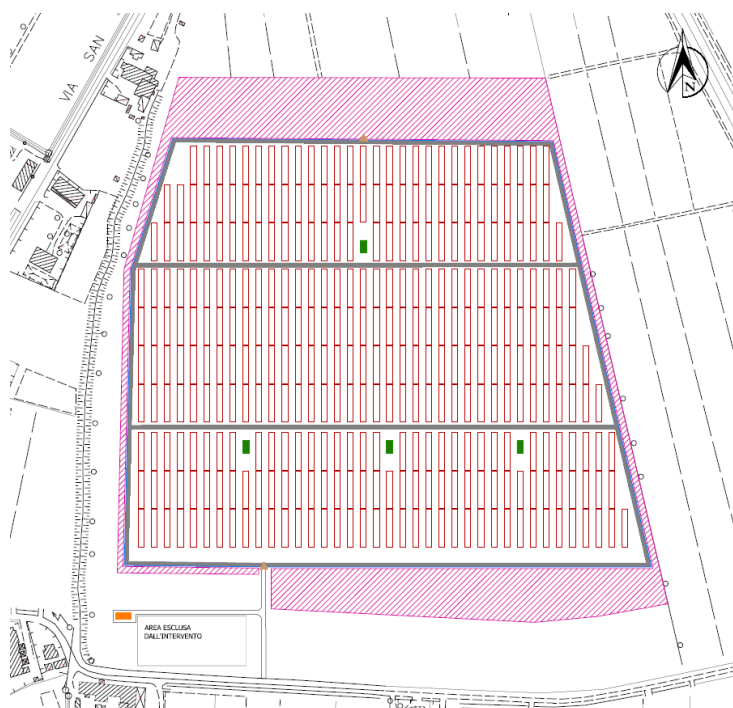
Layout generale dell'impianto fotovoltaico
